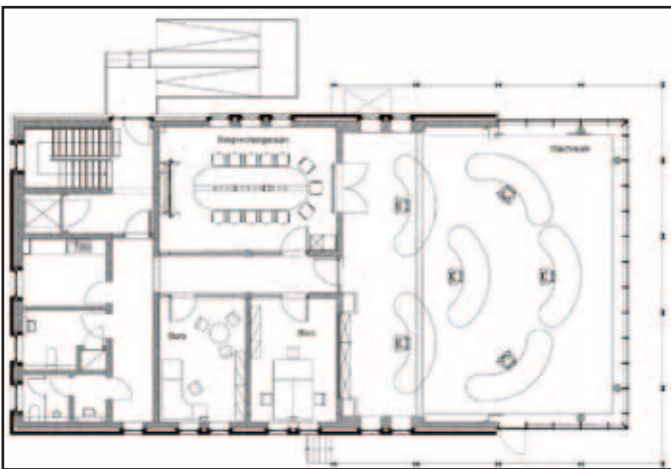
Obergeschoss mit dem Wachraum, der Pantry, zwei Büros und dem Lagezimmer
